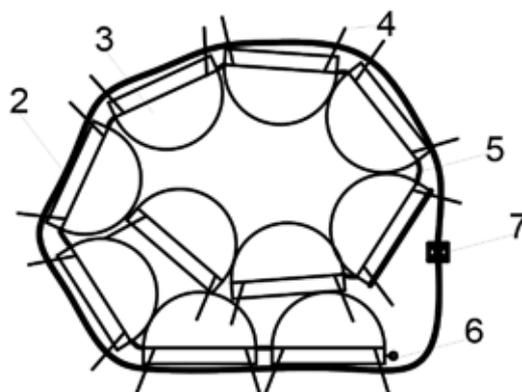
Гибкое бетонное защитное покрытие, свернутое в рулон
